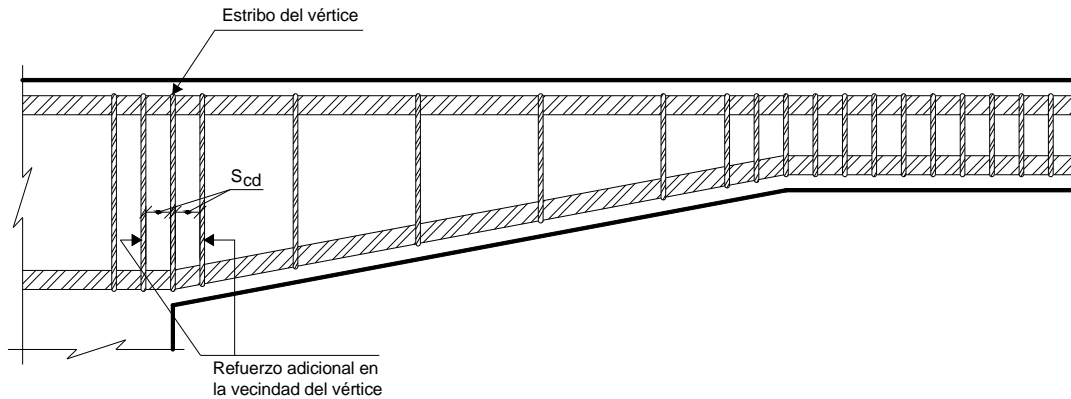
Refuerzo transversal en los vértices de la trabes (López 2011)
